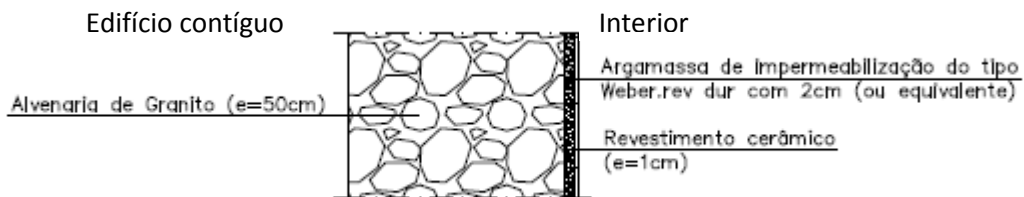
Pormenor construtivo da parede Pi4 [17]
